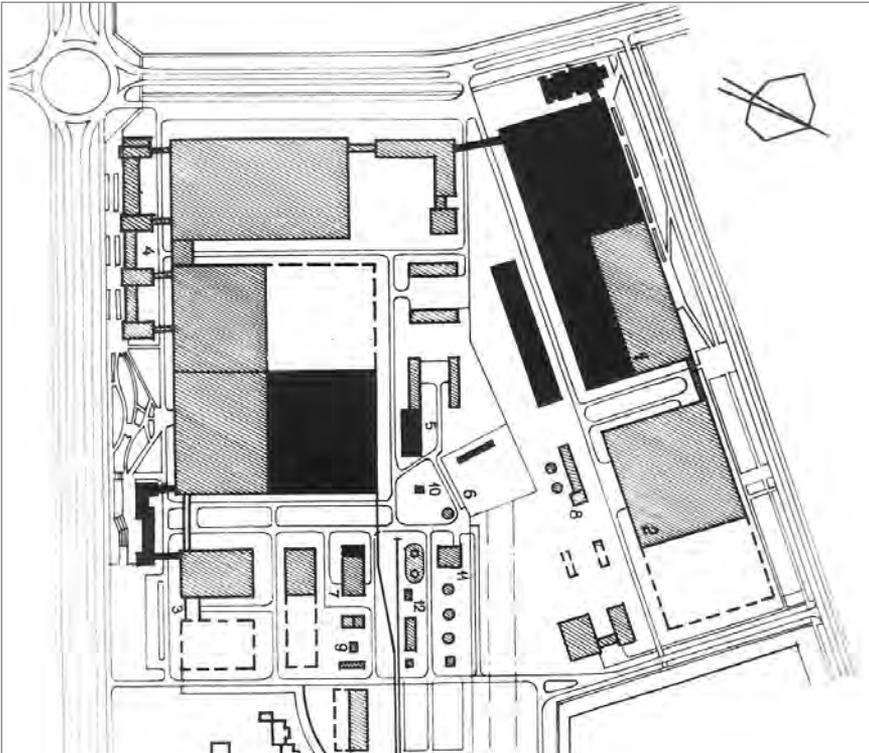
Схема плана промышленного узла Восточный в Бресте, Беларусь
